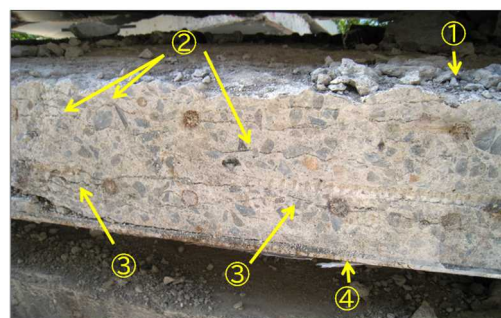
RC 床版の切断面観察(国道 158 号, H 橋)
